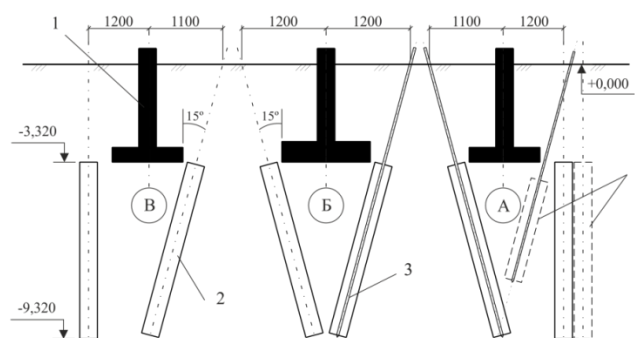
Схема закрепления грунтов основания в поперечном сечении:
